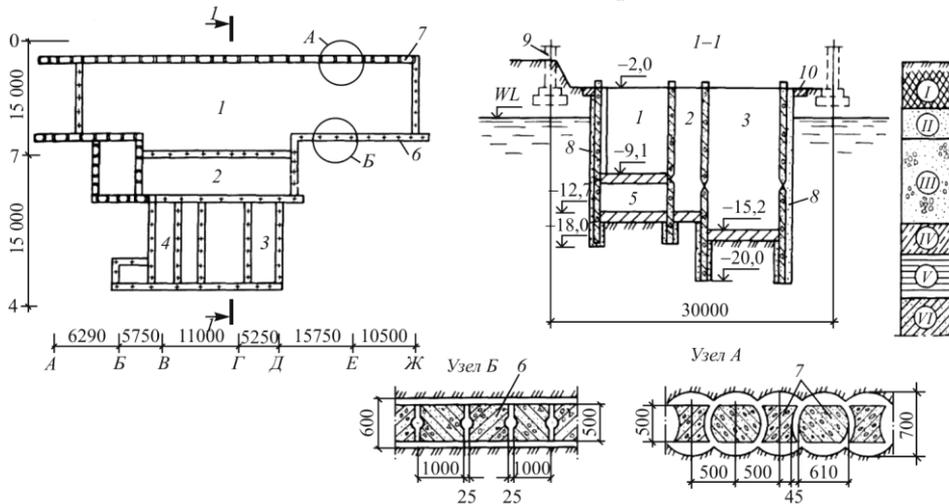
Схема заглубленных подземных сооружений на строительстве завода «Серп и молот» в Москве: 1 – помещение УНРС; 2 – проходной тоннель; 3 – помещение насосной станции; 4 – яма окалины; 5 – тоннель гидросмыва; 6 – стены из сборных плоских железобетонных панелей; 7 – стены
